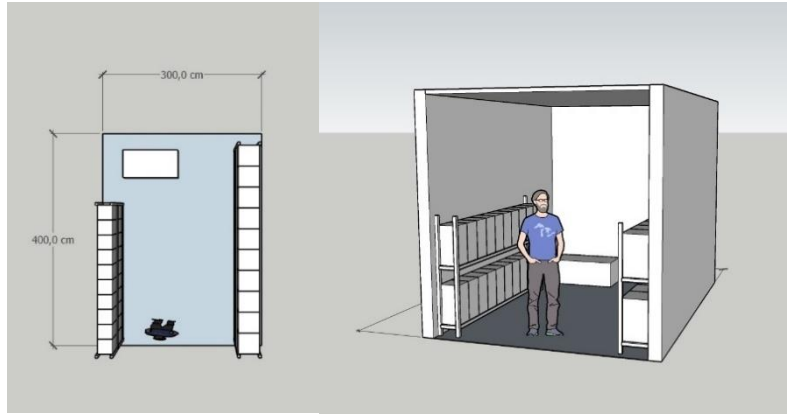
12 Layout Ruang Kios Burung Tipe A
